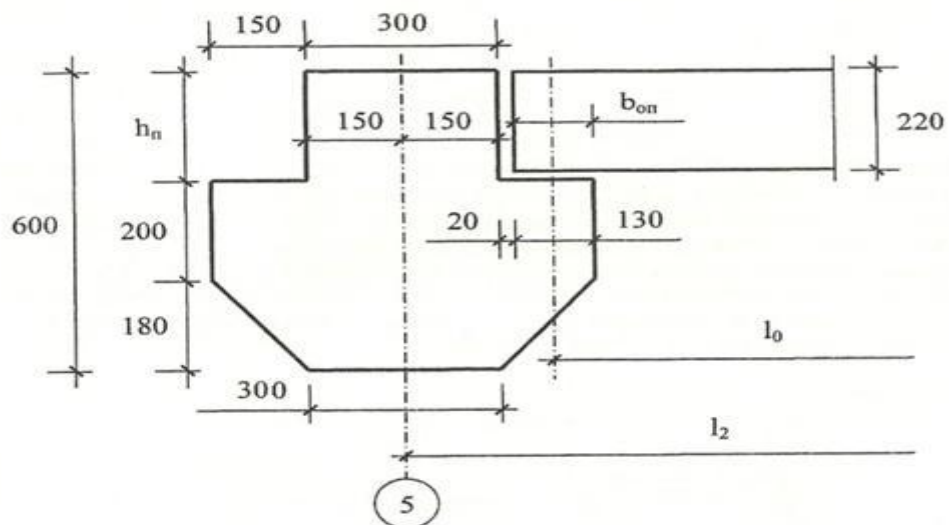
Схема узла опирания панели на полку ригеля крестового сечения
